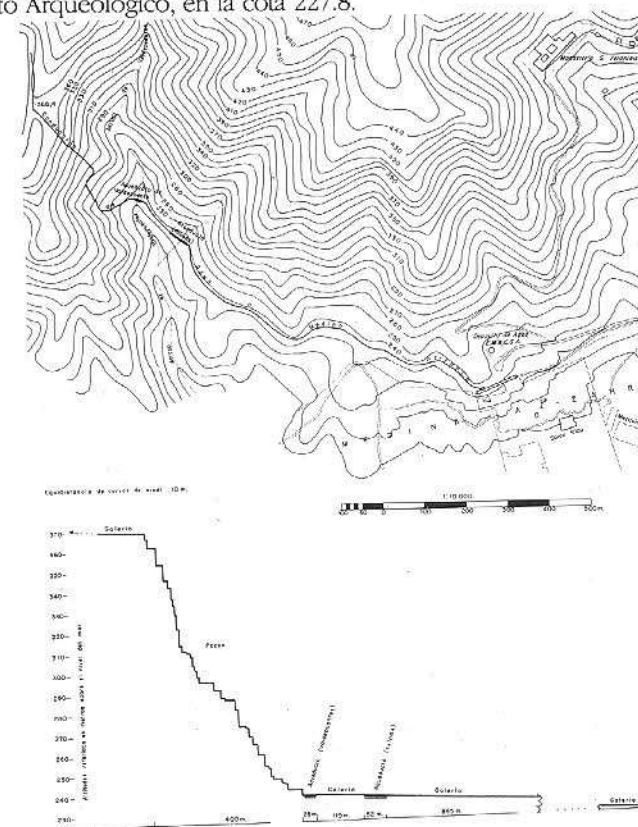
Tramo Fuente de la Teja - Madīnat al-Zahrā', según López-Cuervo. Planta y perfil.
